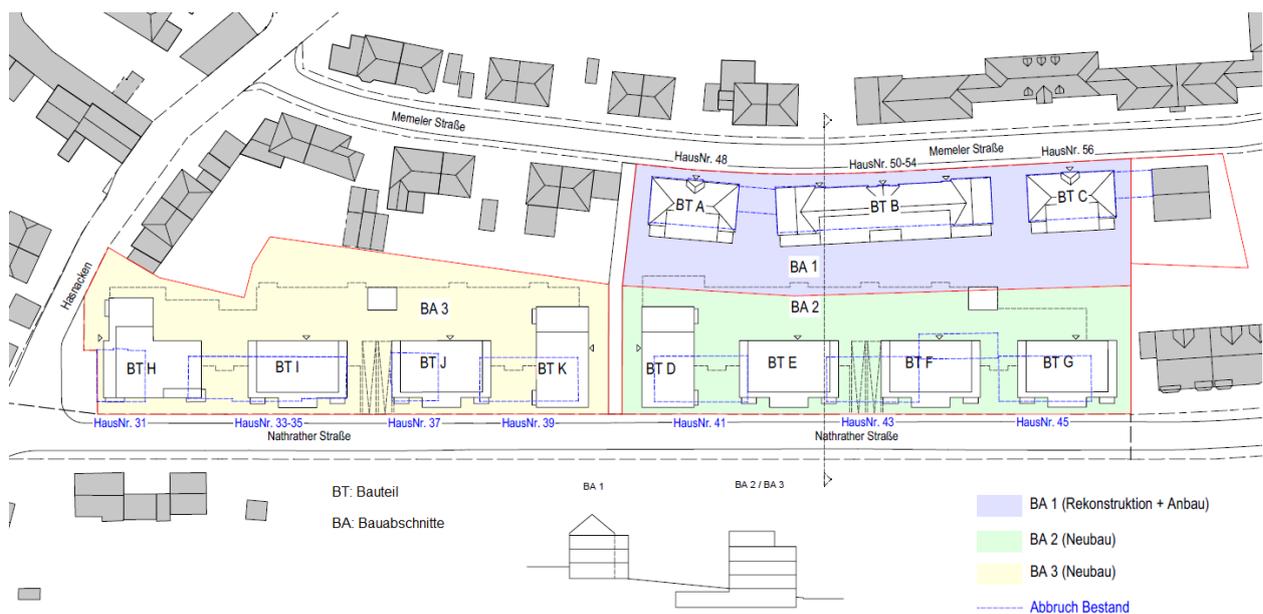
Übersicht, Bauabschnitte (Quelle: HGMB Architekten)
